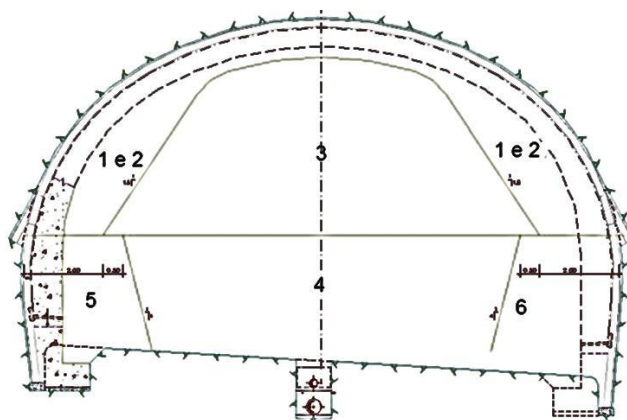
Faseamento de escavação em zona ZG3 em secção de alargamento com aplicação de cambotas HEB180
